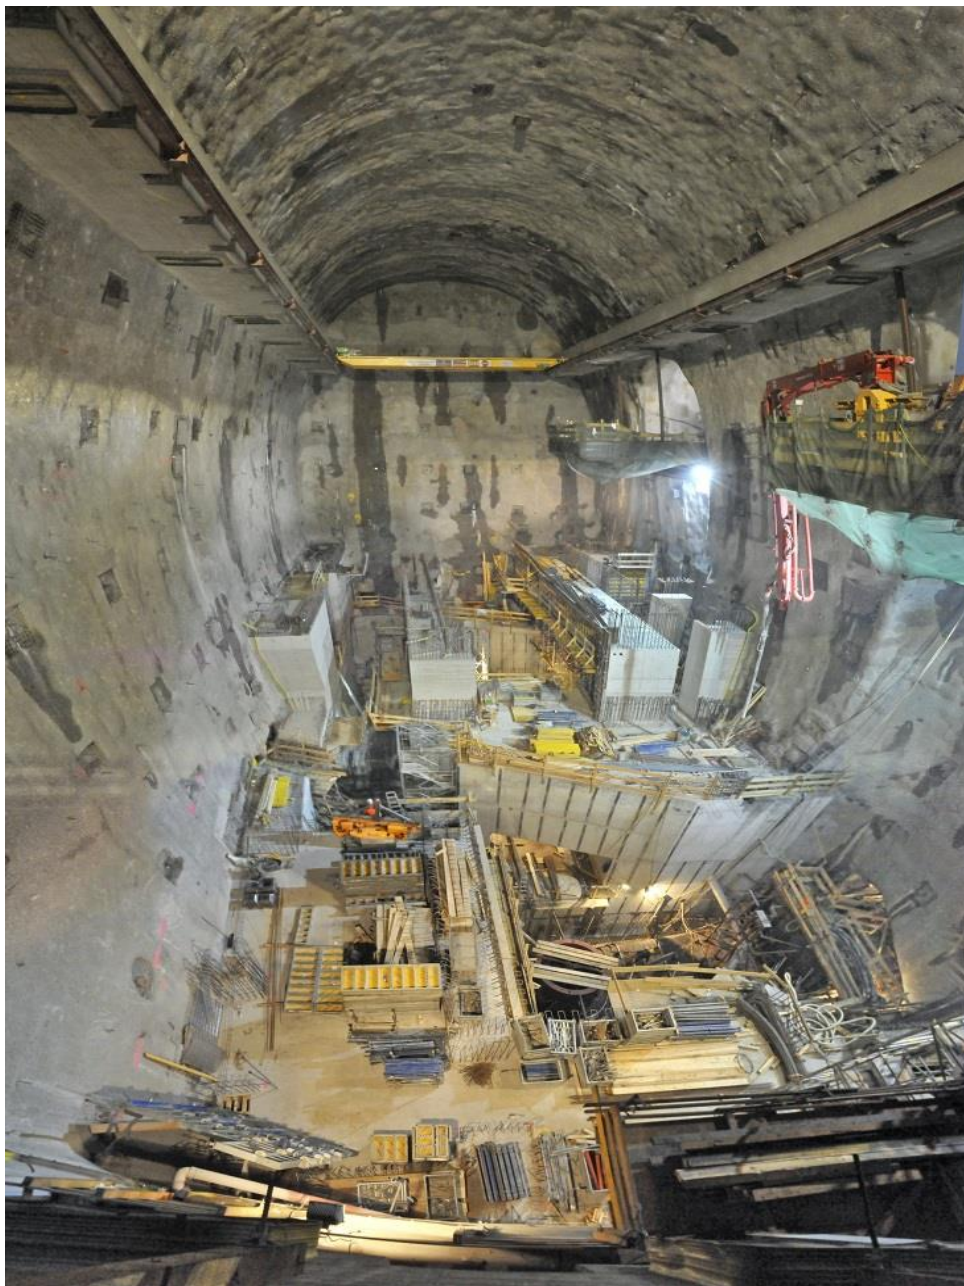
Підземна машзала ГАЕС перед закінченням будівництва (стіни закріплено попередньо-напруженими анкерами та омоноліченим набризк-бетоном)
